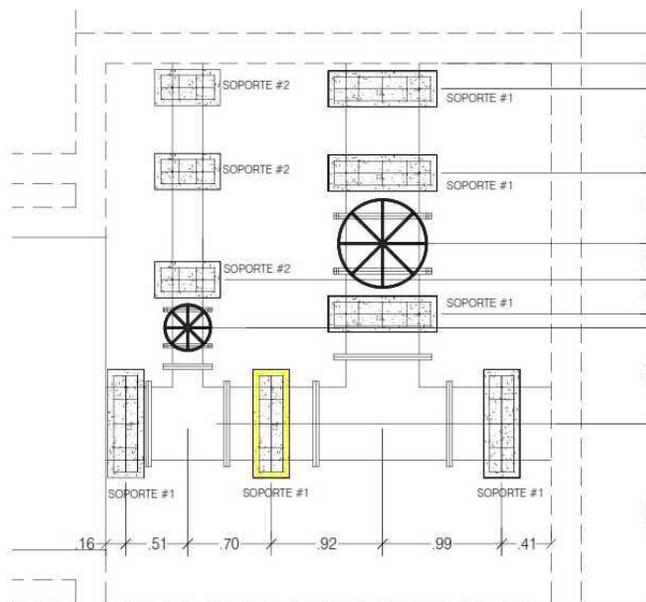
Se verifica en los planos la posición del soporte a fundir. Fuente Diseñador Estructural Ing. Pablo Ramírez.
